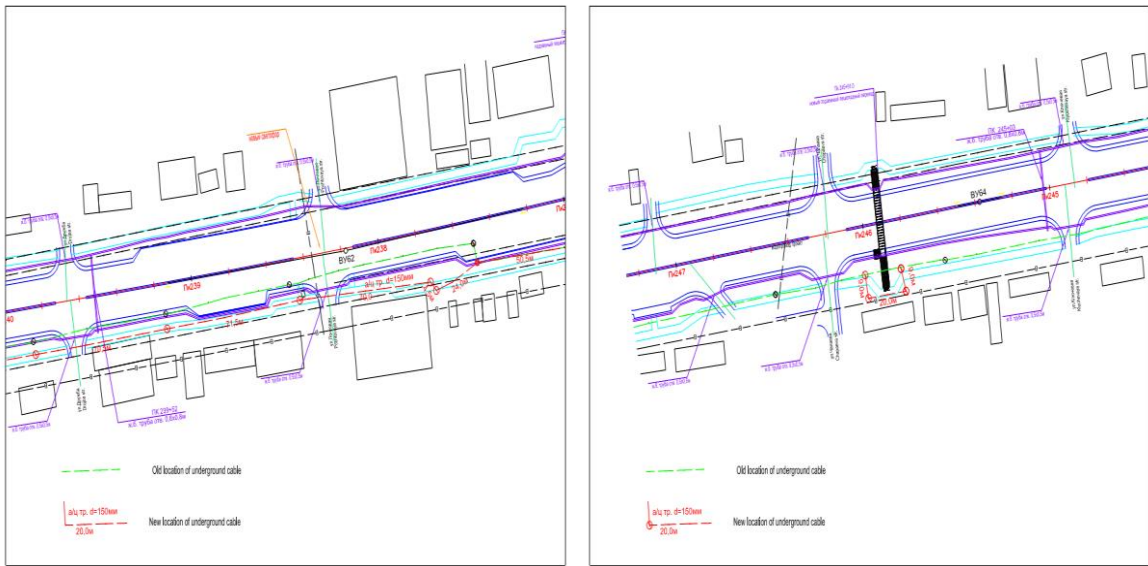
Размещение бетонных труб для подземных кабелей связи
